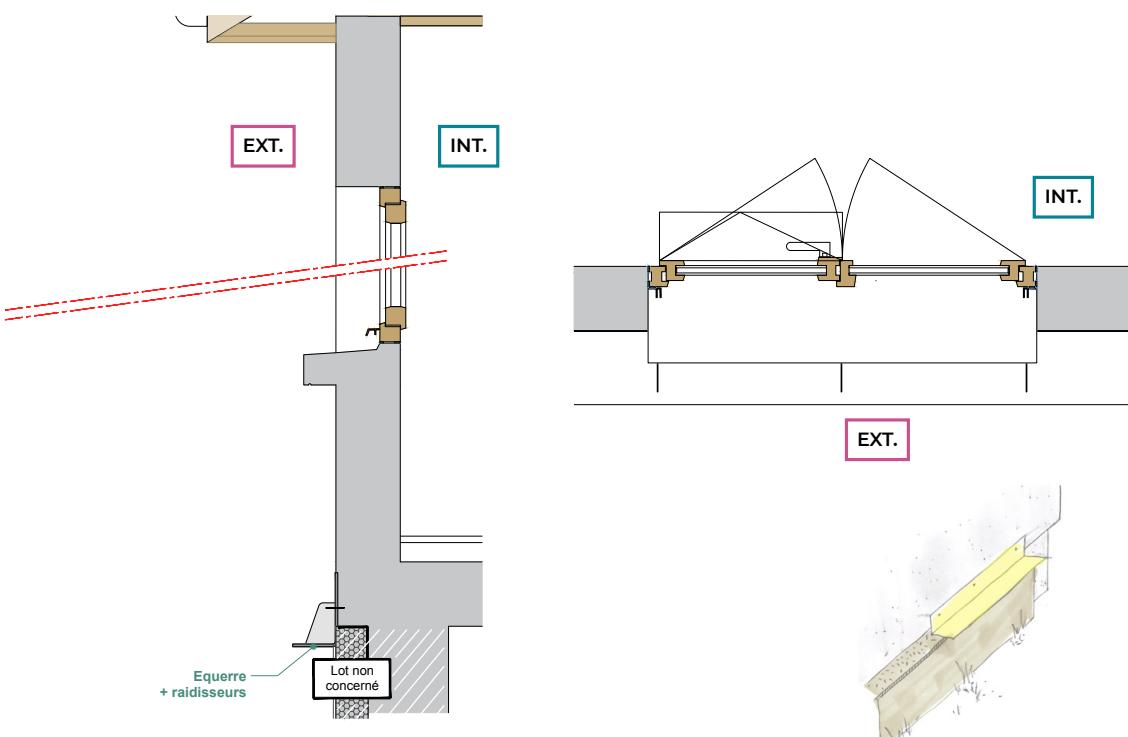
Fixation de l'équerre métallique (au niveau des dalles de planchers)
